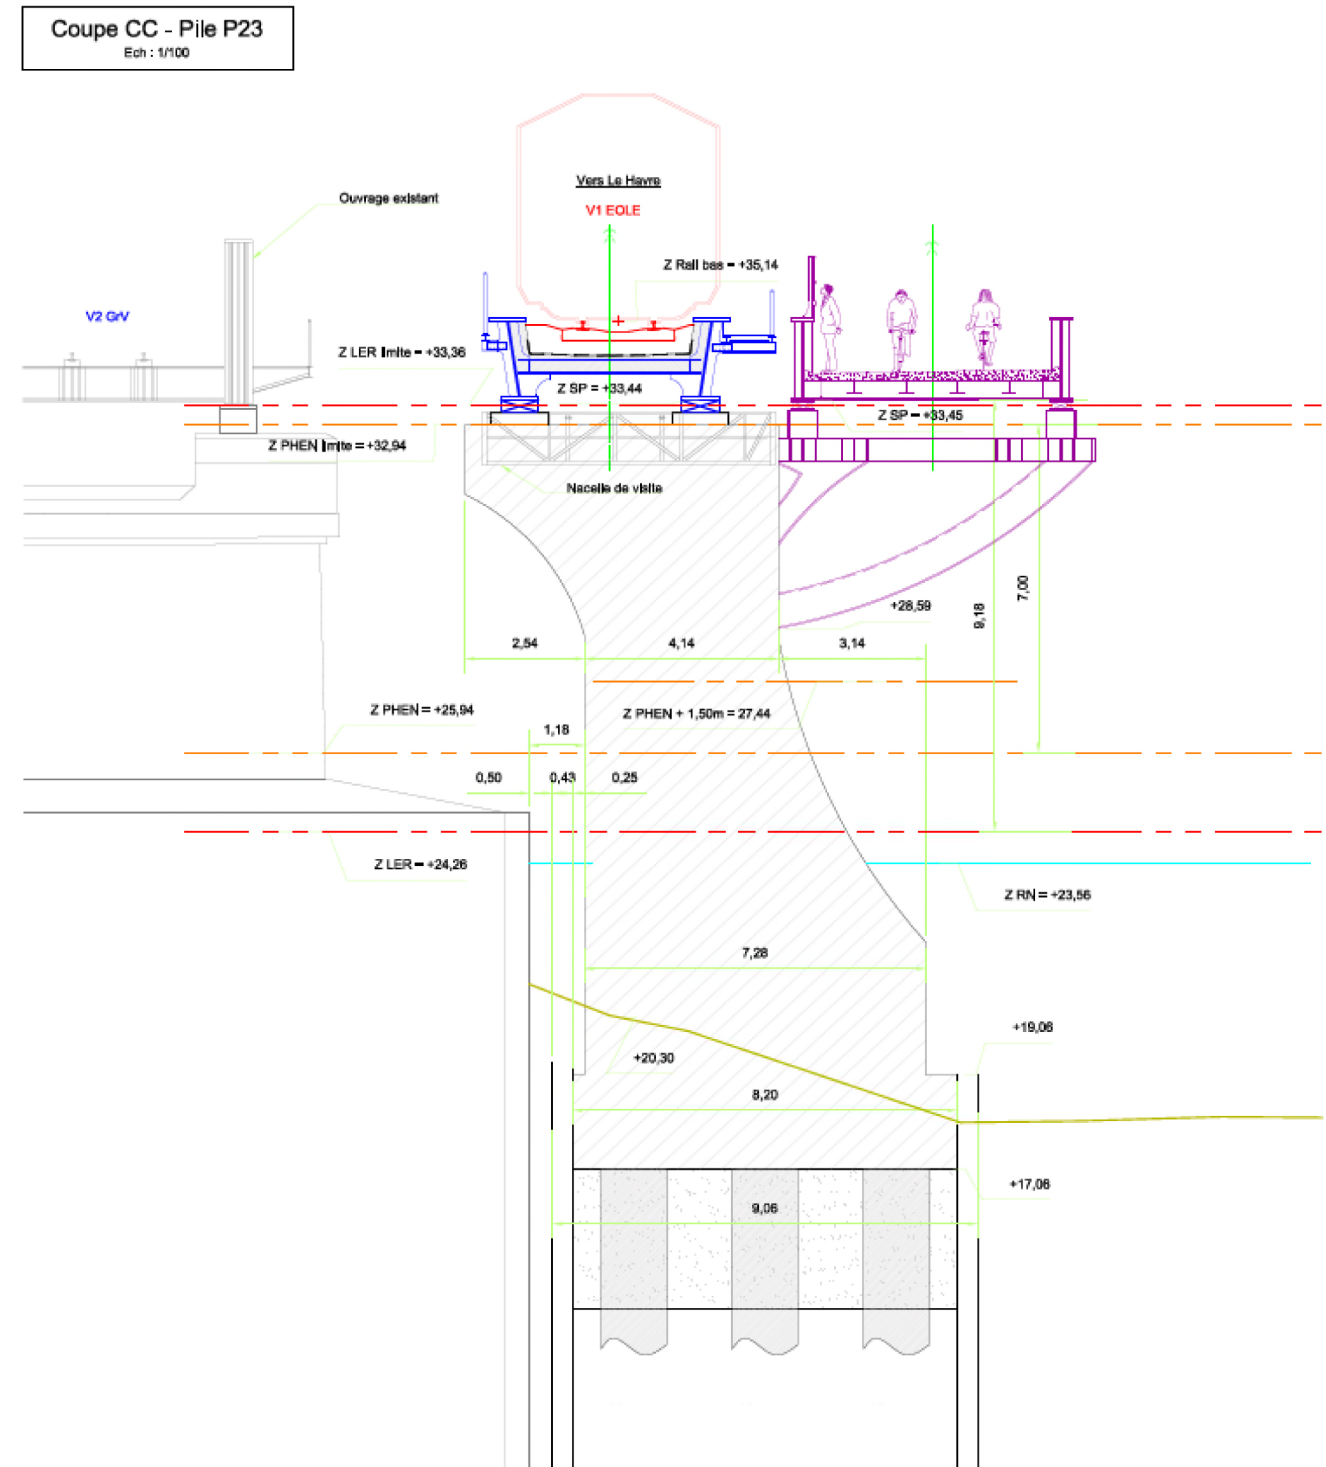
Vue en coupe de la pile P23 : bras de la Rivière Neuve (bras droit)
